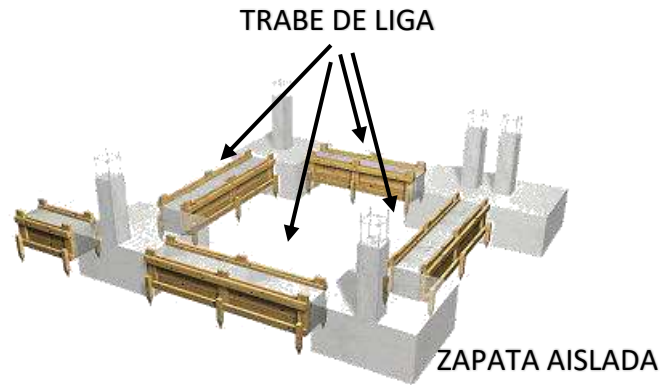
Detalle de cimentación de zapatas aisladas unidas por través de liga.
